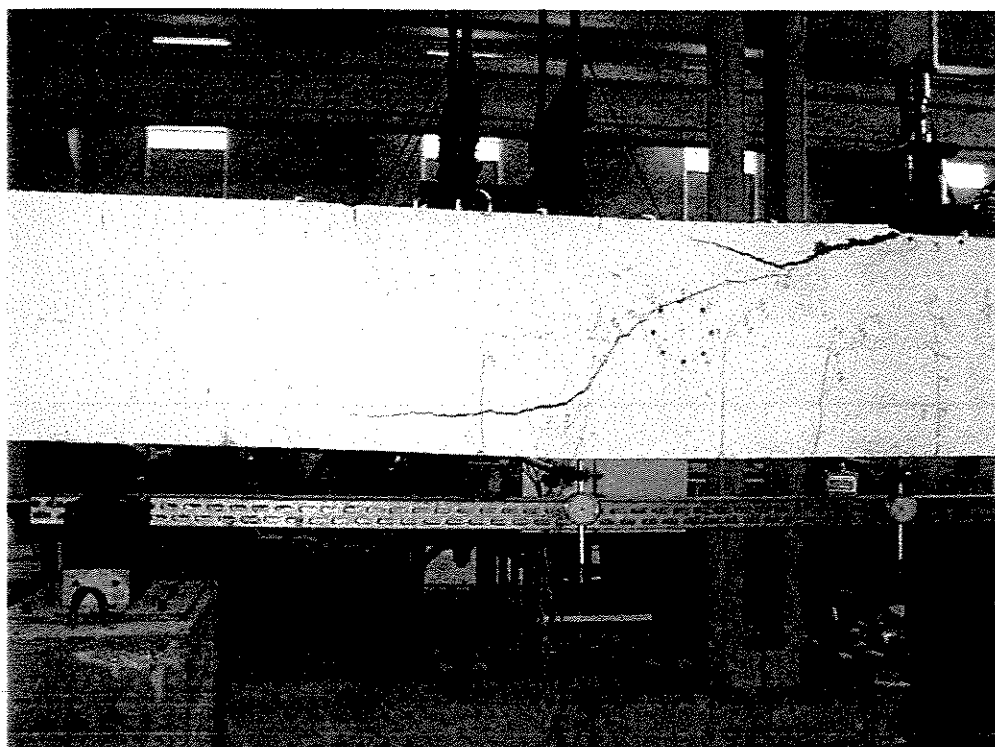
VIGA 2BL-CIS APÓS ENSAIO
